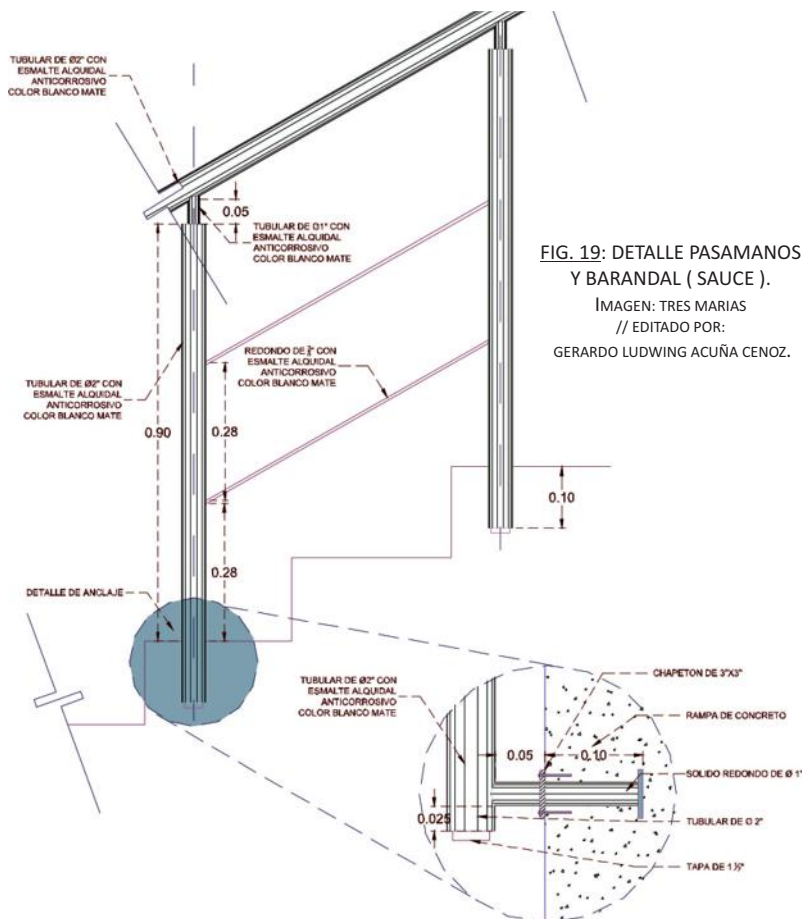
DETALLE PASAMANOS Y BARANDAL (SAUCE).
